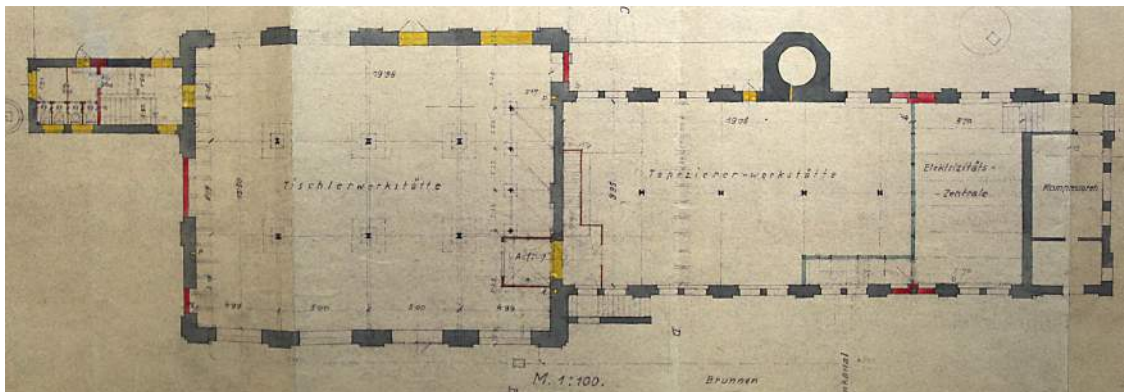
Grundrissdarstellung des Parterre sowie Hochparterre; Planmappe 1938
